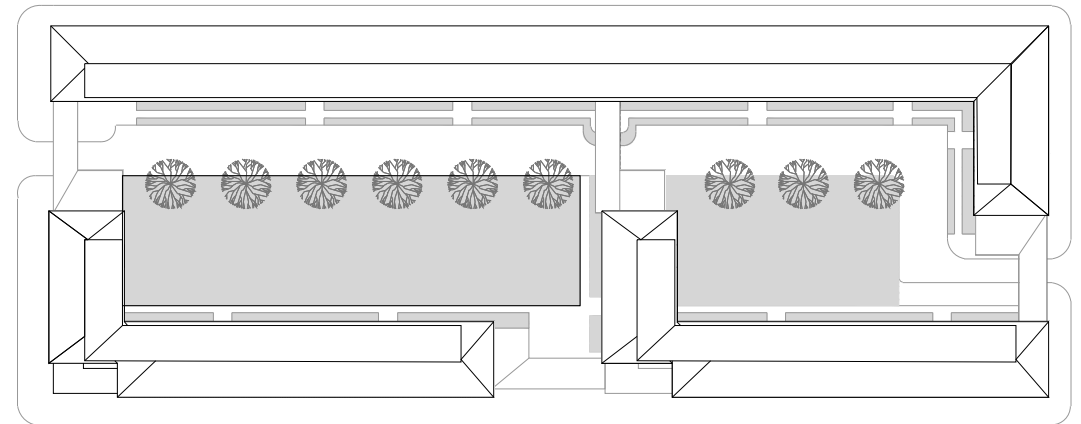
, 44, 45, 46 y 47. Planta Baja, Planta de techos, Sección Longitudinal, Sección Transversal y Fachada E 1: 1000
